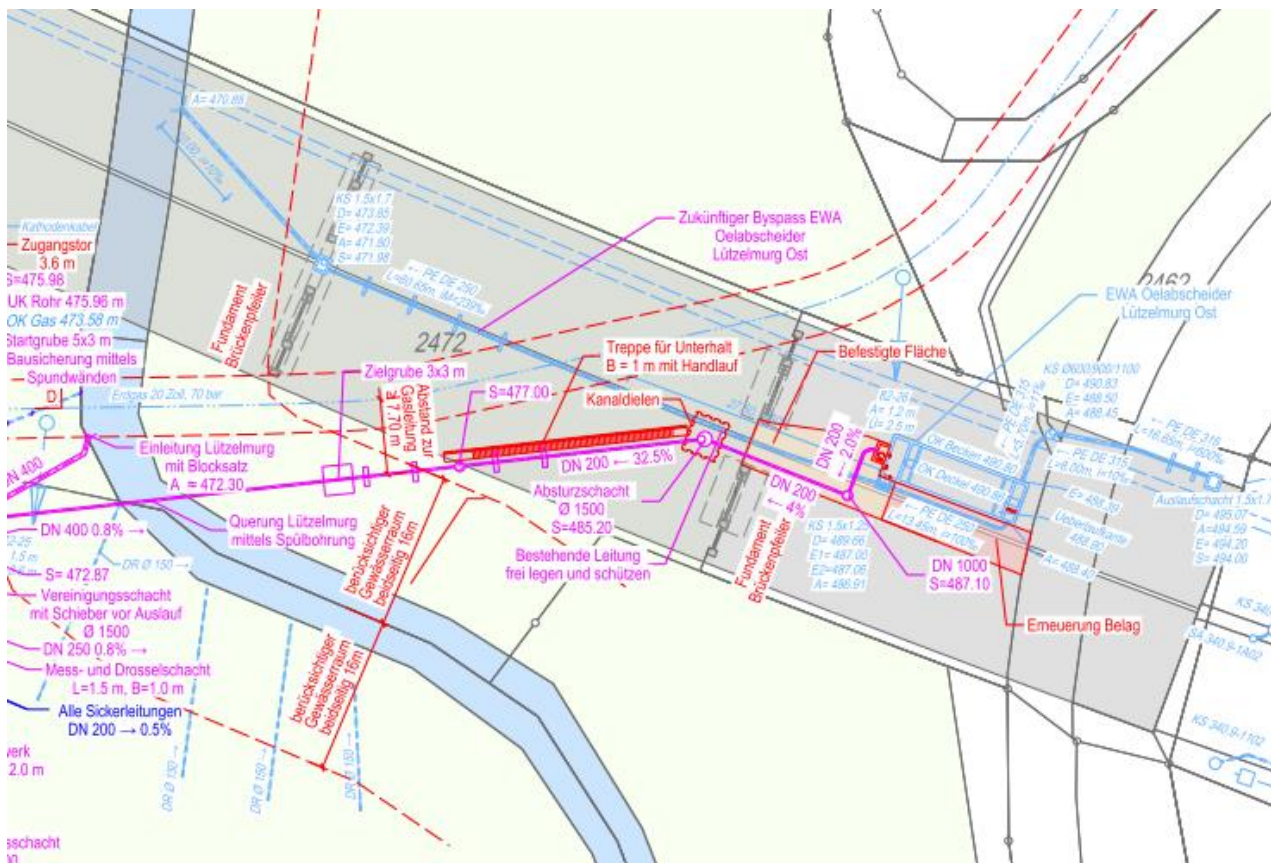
Ausschnitt aus dem Situationsplan (1:500) von Basler&Hofmann, in dem man die Lage der Zugangstreppe (nicht-forstliche Kleinbaute) erkennt
